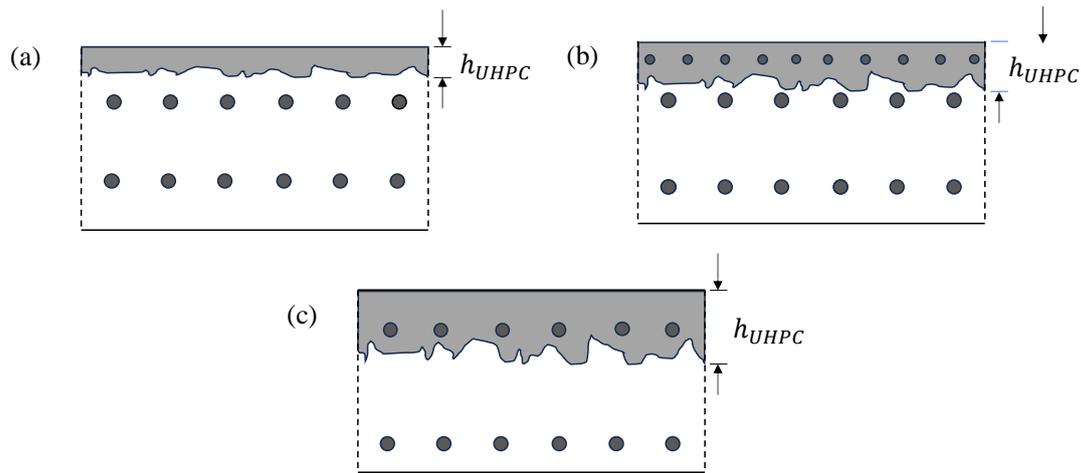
混凝土基层与 UHPC 铺装层内典型的配筋示意图
